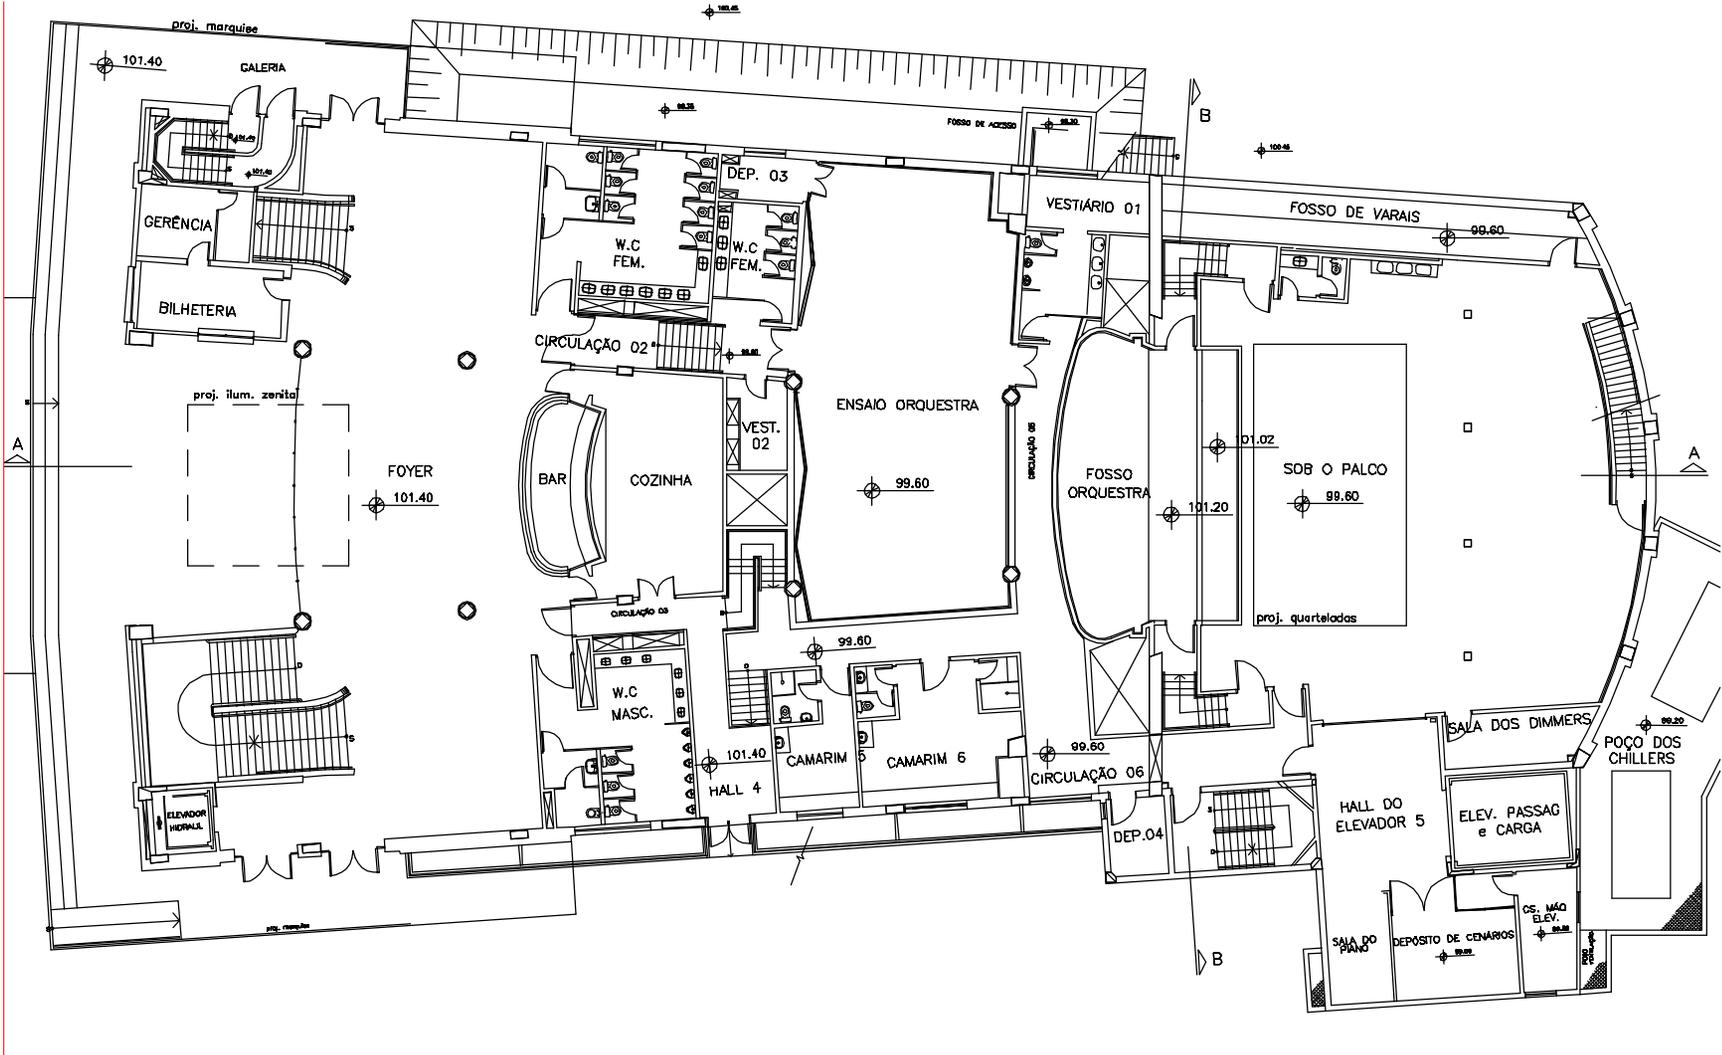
Planta do Pavimento Térreo – Teatro Alfa de Cultura – Esc. 1/250
